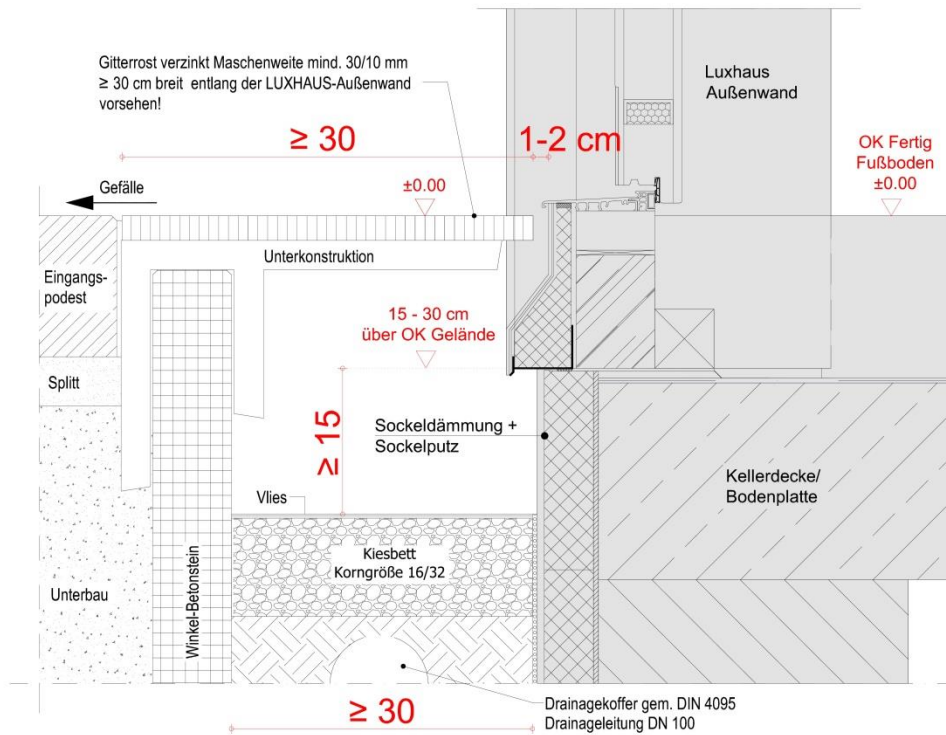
LUXHAUS Sockeldetail 7 - Hauseingang mit Kiesbett
